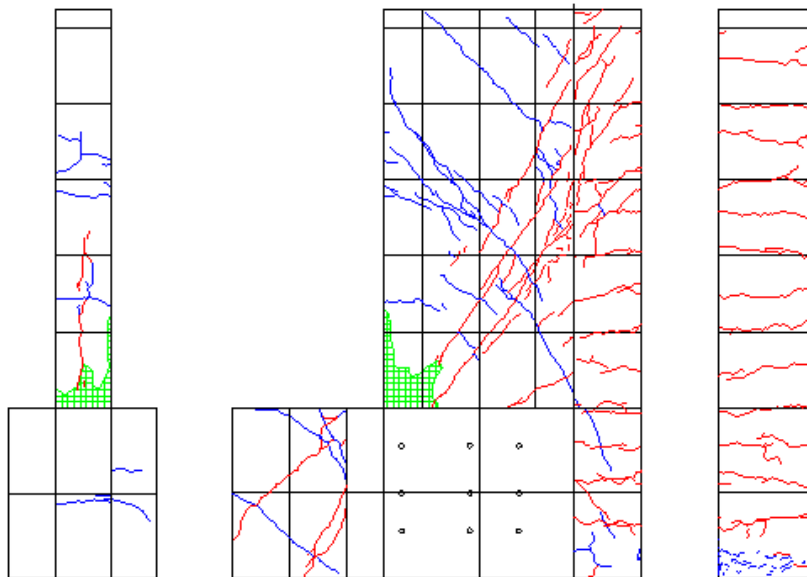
R=-1/33 ひび割れ図
